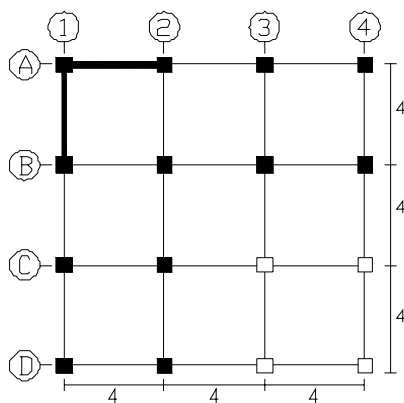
Vista en planta de la variante M3, para el edificio de 8 niveles
